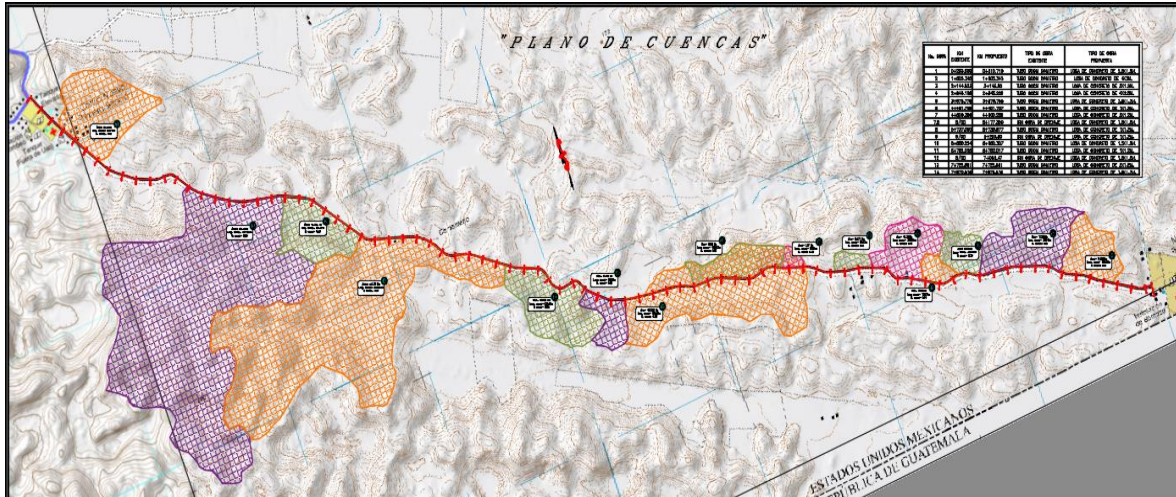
PLANTA DE CUENCAS DEL PROYECTO
